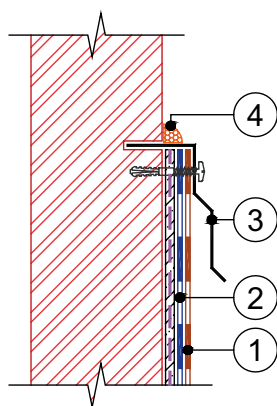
Краевая рейка на стене из бетонных плит
